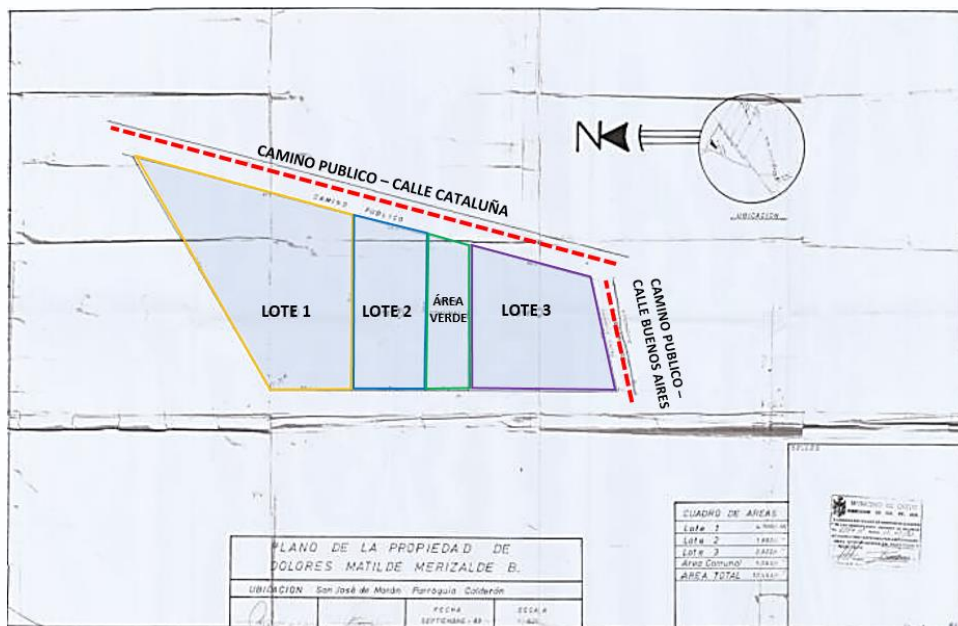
Plano de subdivisión 1983 Fuente: DMQ
